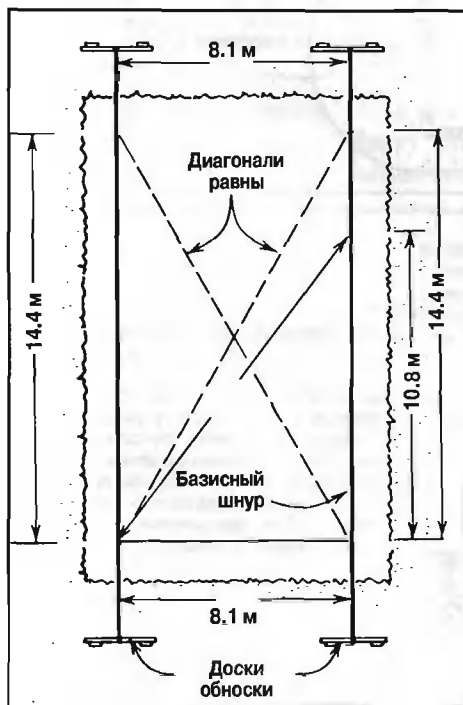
Разметка прямых углов фундамента способом расчета углов прямоугольного треугольника со сторонами «3–4–5»
